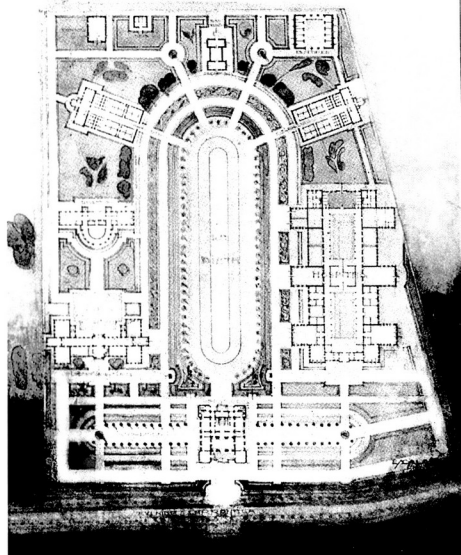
Planta general de la Escuela de Veterinaria, proyecto.
